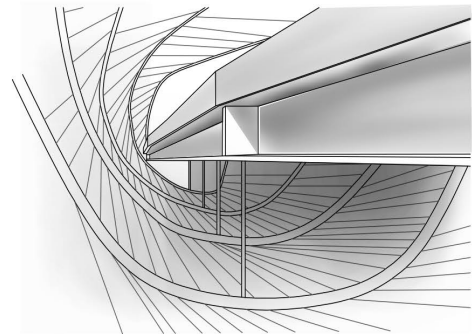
Dibujo de la autora de la sección característica de las caracolas apoyadas sobre muros de hormigón
